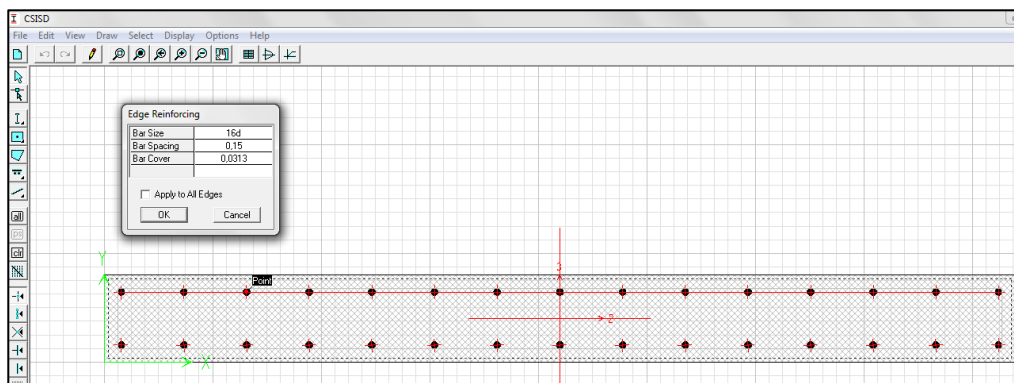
(e) Detalle del armado del muro para pisos bajos.
